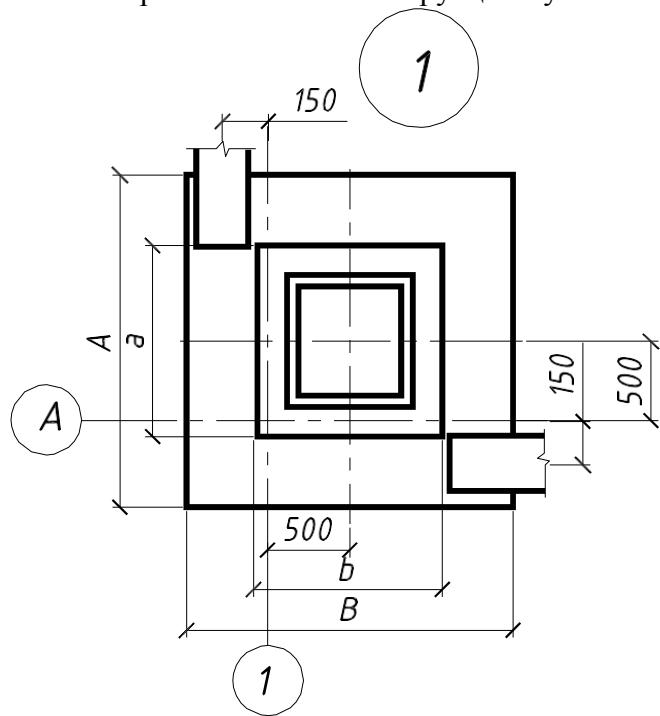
Узел опирания фундаментных балок на угловой фундамент
